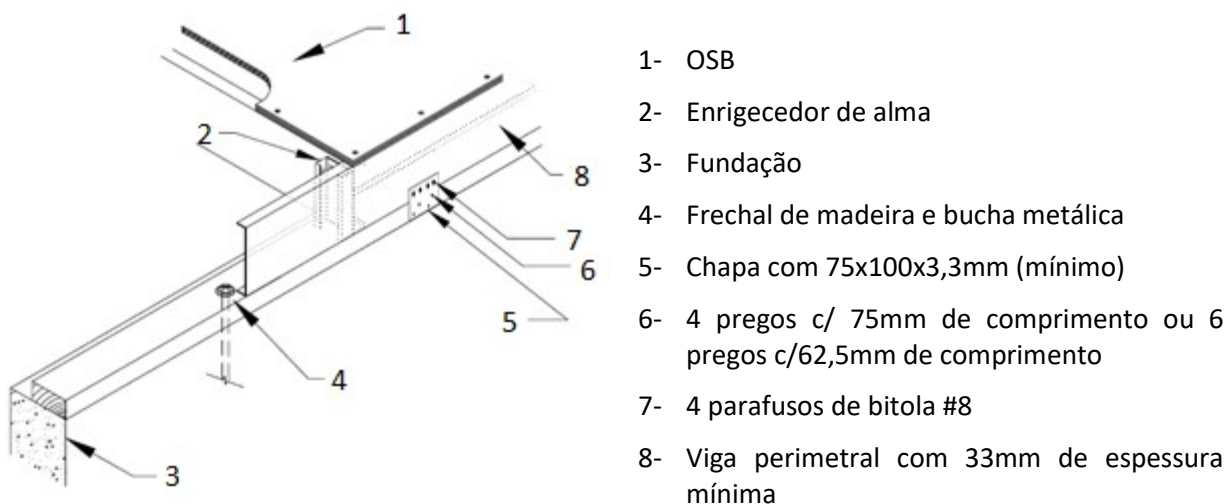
Ligação do pavimento de LSF com frechal de madeira em parede (AA.VV., 1997)
